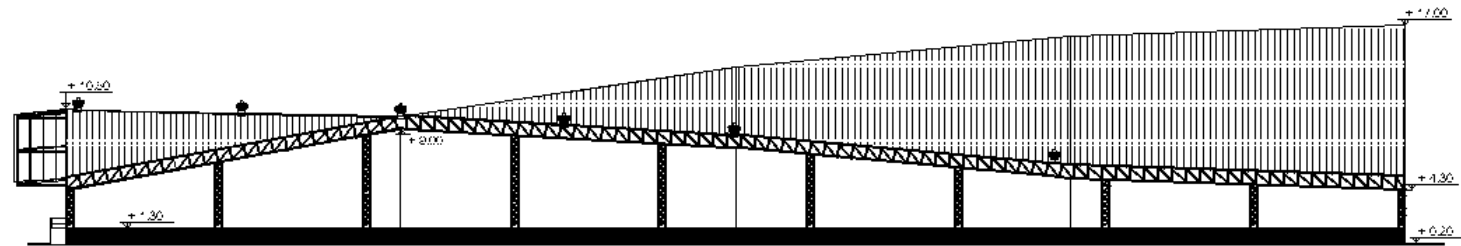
Planta arquitectónica de Galpón Contorno
